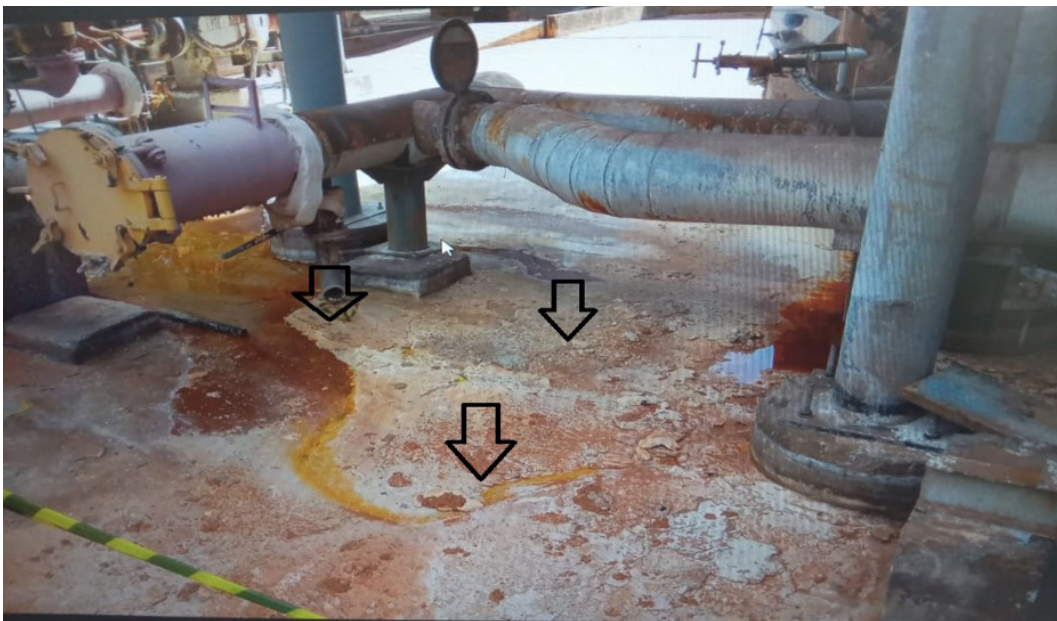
Degradação do concreto e fissuras mapeadas.
